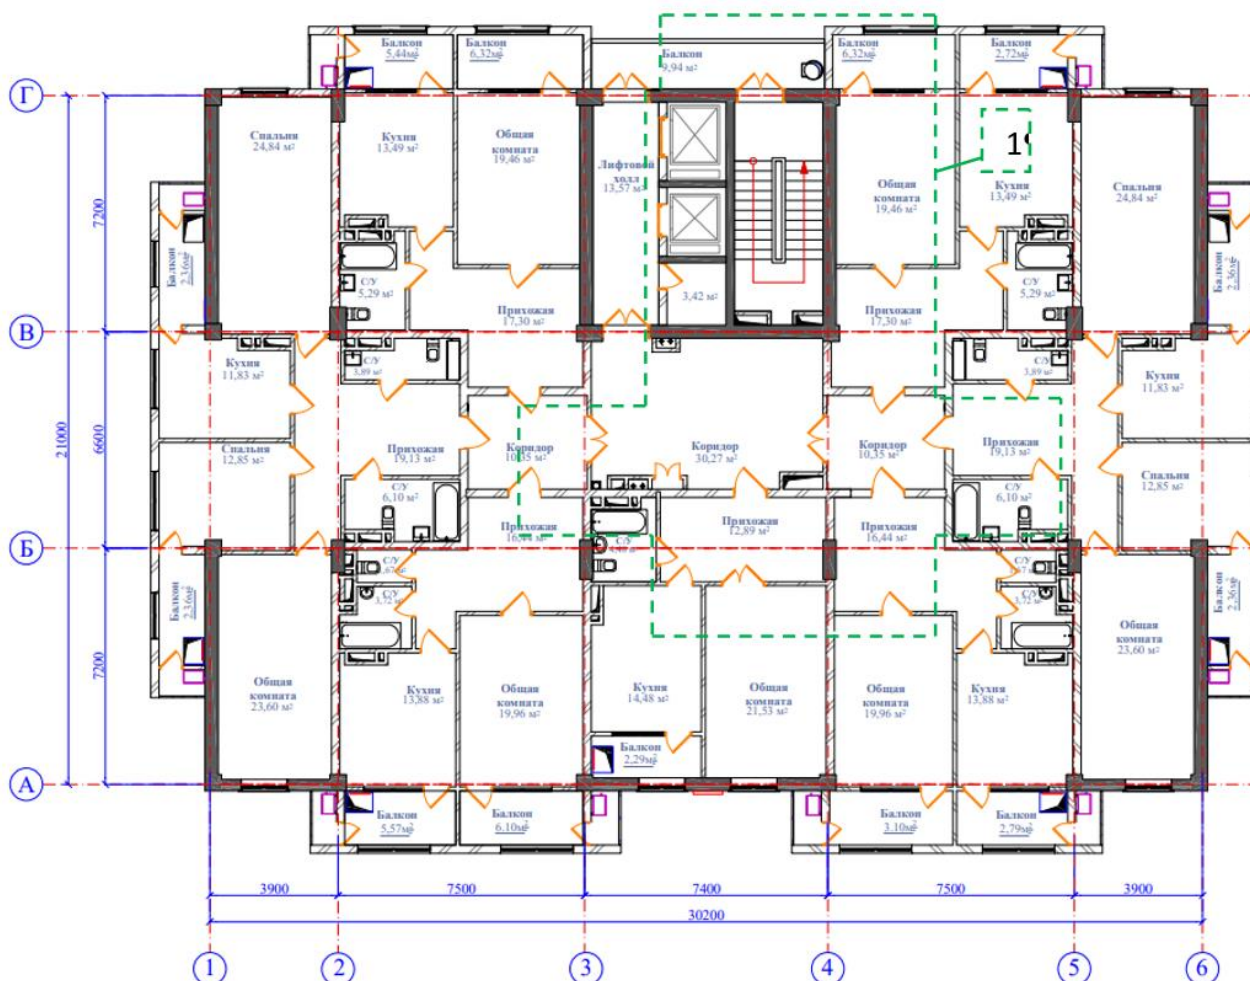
План типового этажа жилого здания для МГН 1-фрагмент
